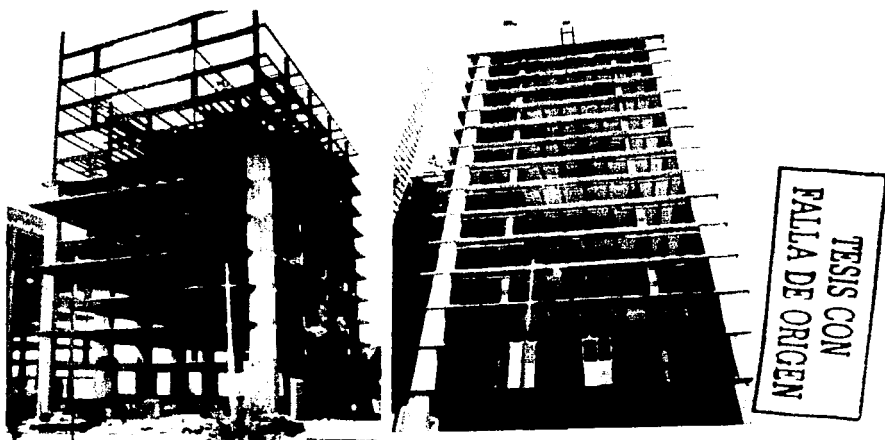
Alternación en la colocación de elementos de apuntalamiento
